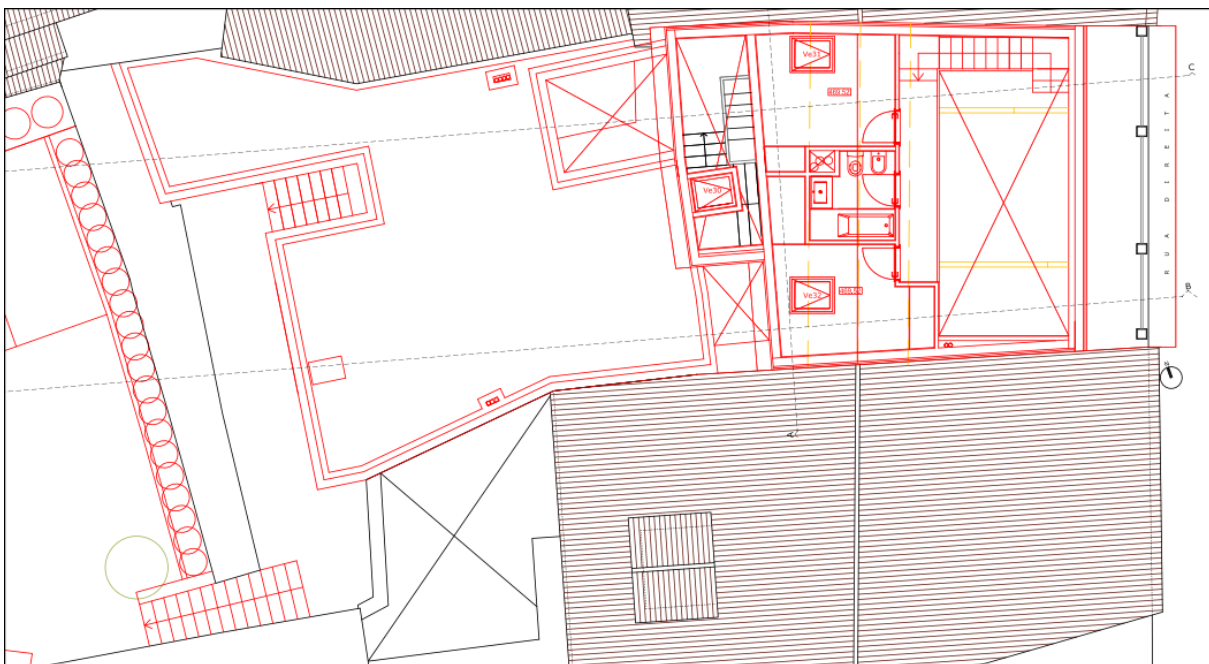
Planta do desvão da cobertura do edifício 2 em estudo
